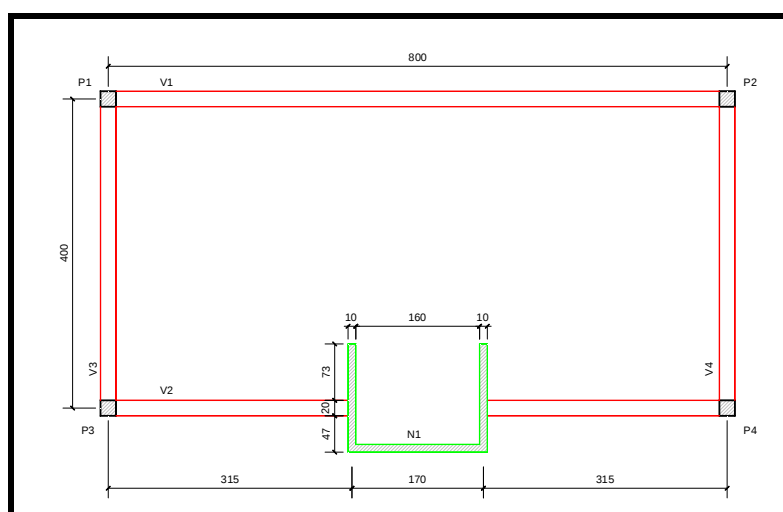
ã Pórtico espacial em planta (dimensões em cm)
